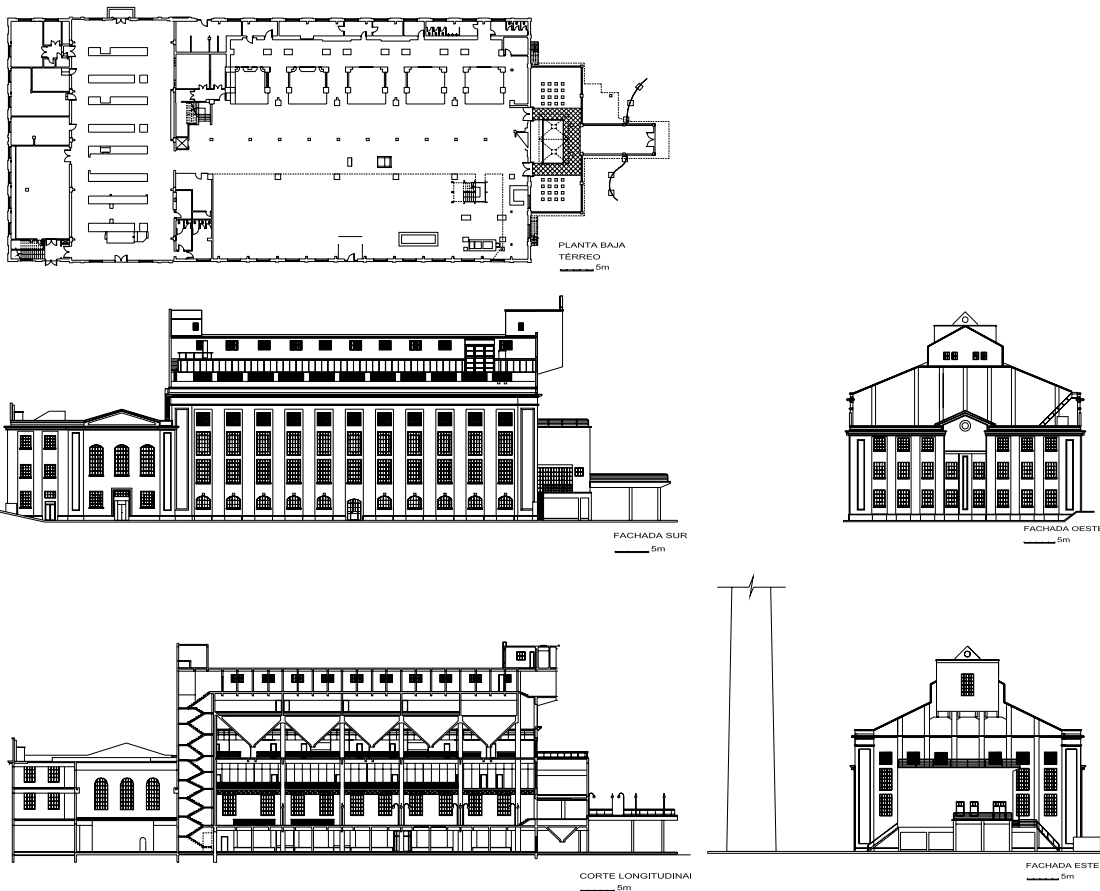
Usina del Gasómetro. Proyecto de restauración. Planta baja, fachadas y cortes. Fuente: Acervo EPHAC.
